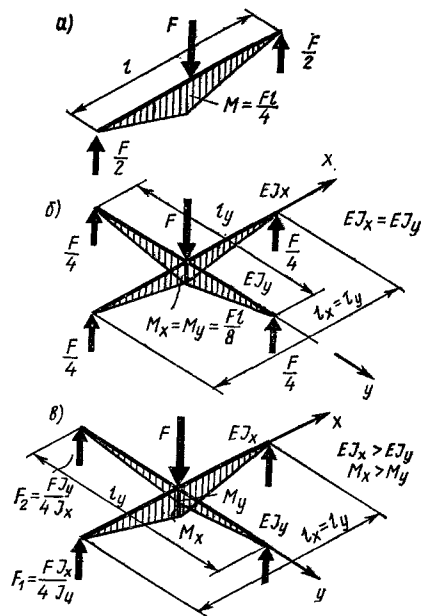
К работе перекрестных балок (а—в) на сосредоточенную силу
